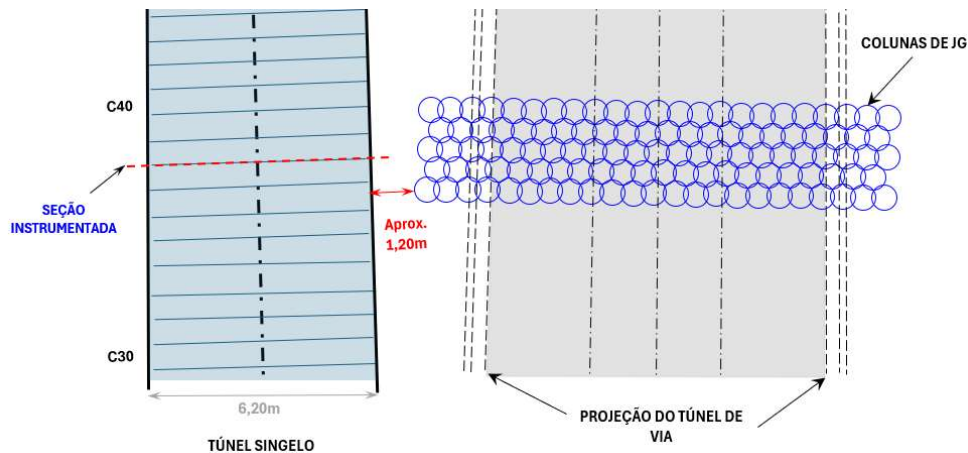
Localização da seção instrumentada e das colunas de *Jet Grouting* (JG)
